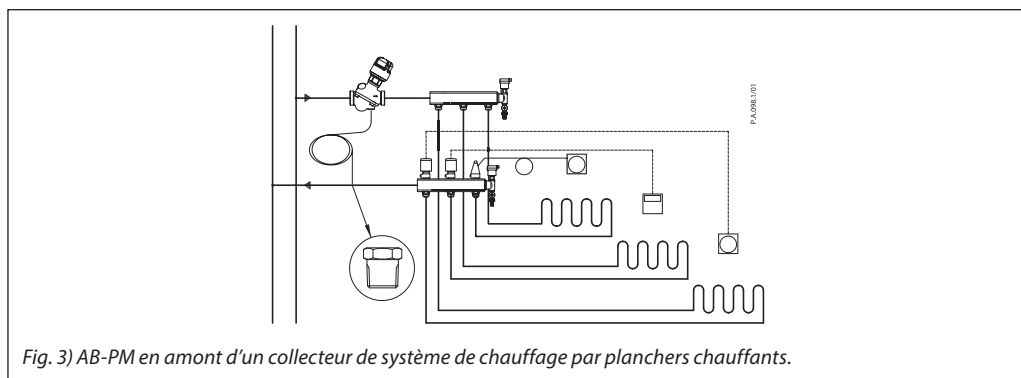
AB-PM en amont d'un collecteur de système de chauffage par planchers chauffants.
